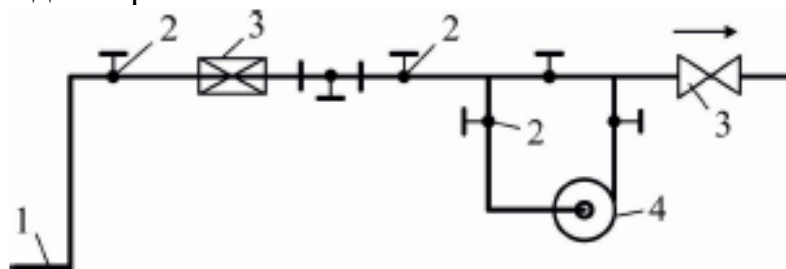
Схема внутрішнього водопроводу без водонапірного резервуара і насоса, що підкачує (з нижнім розведенням):
